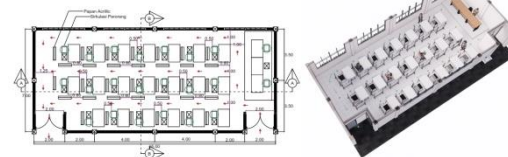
Denah Ruang 3-1 tipe Horse Shoe
